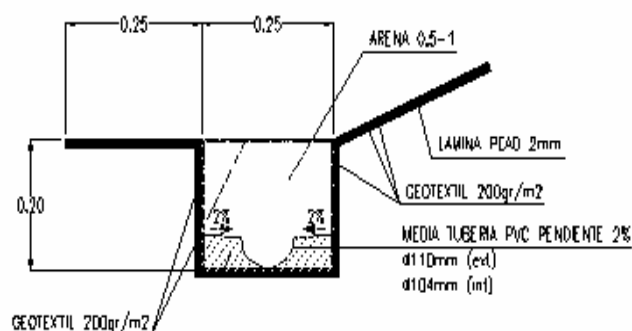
Detalle de la sección de la zanja de drenaje de agua infiltrada.
